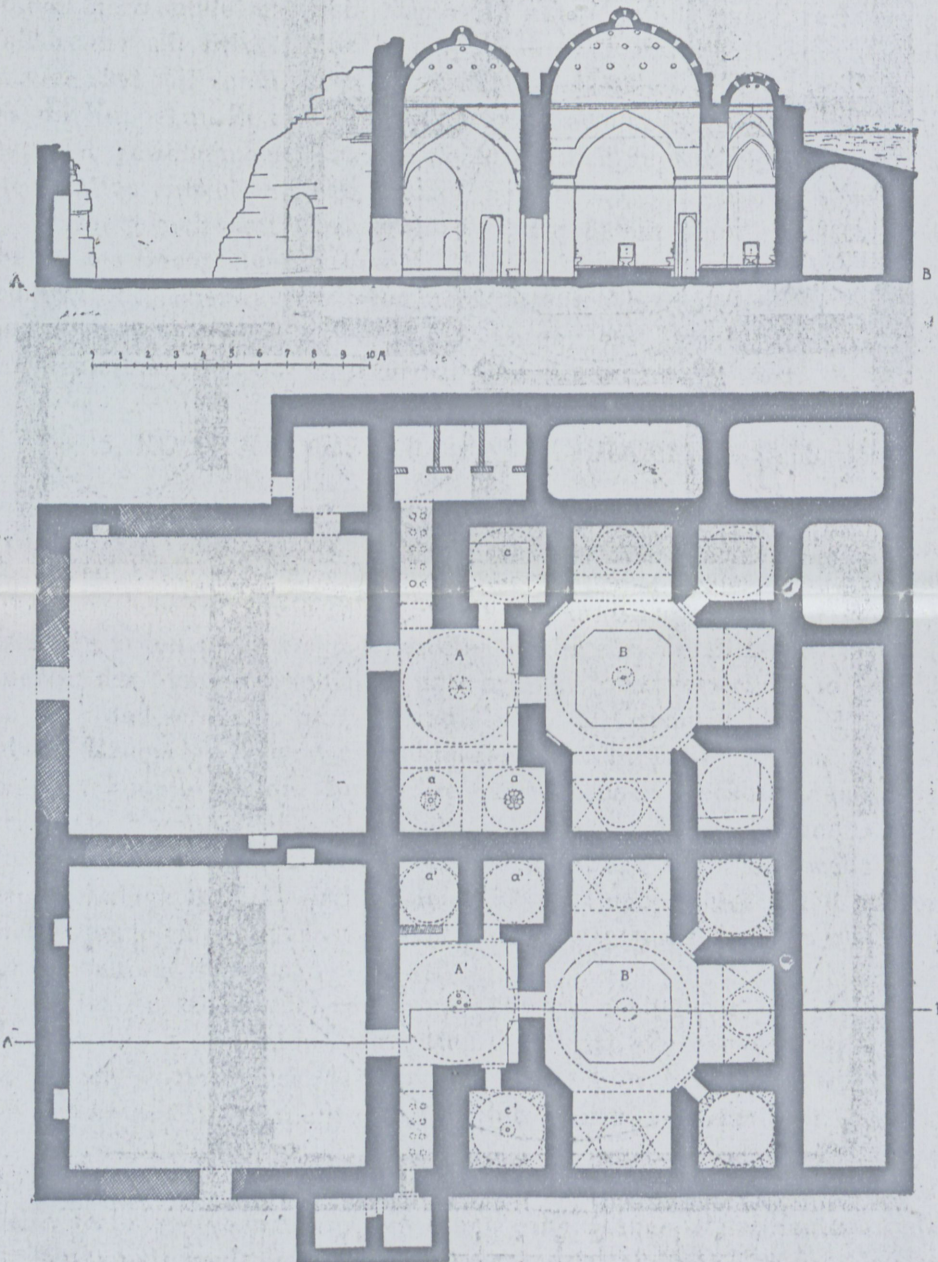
Wlangu Hammam, Grundriß und Schnitt.
